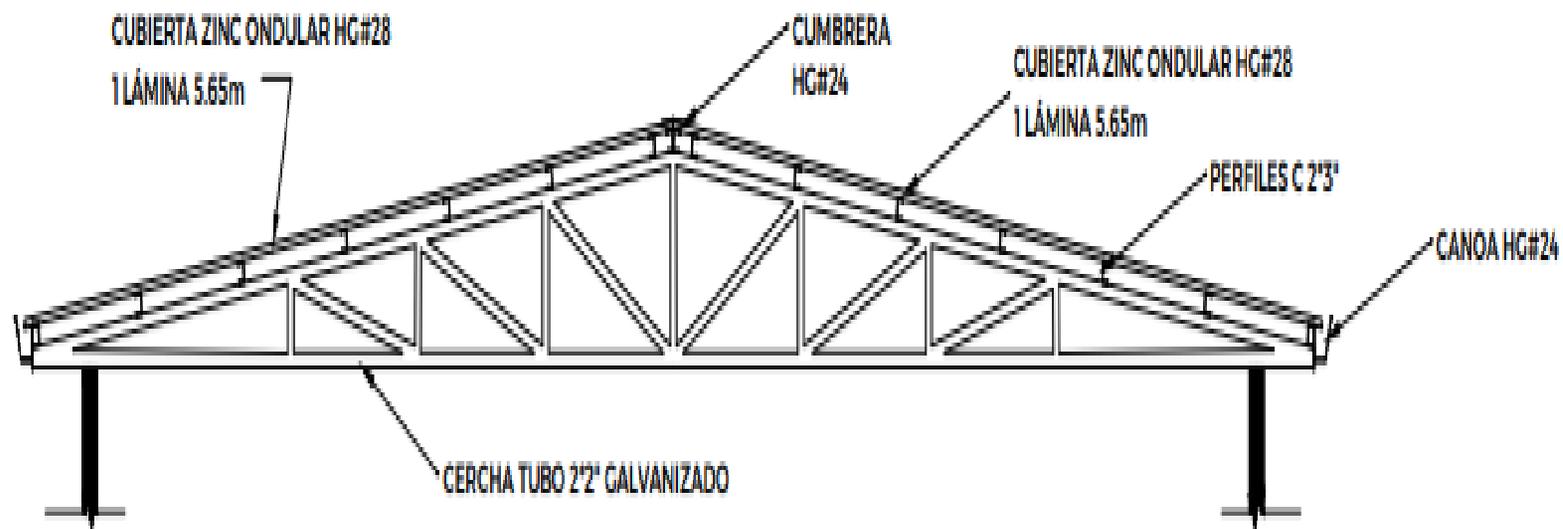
Planta de techos 2 aguas - Sistema constructivo TeknoBlock – lamina prefabricada
